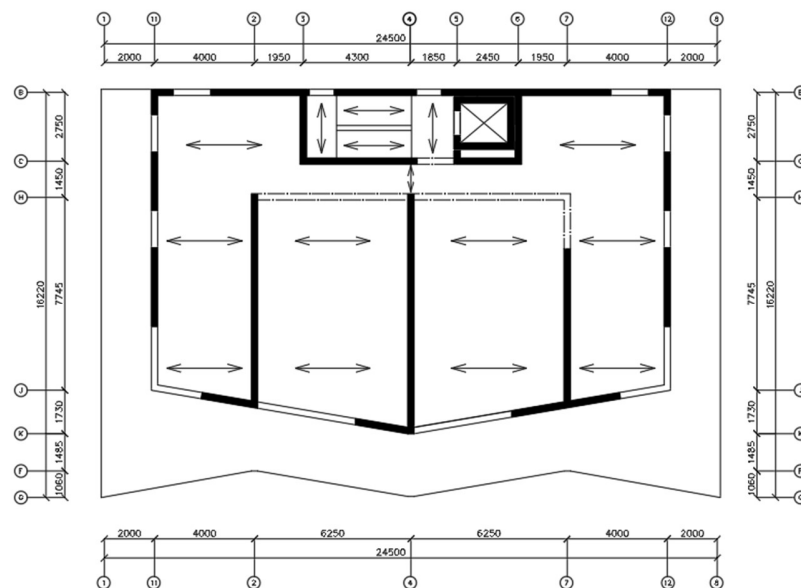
Konstrukční schéma 2.–5. NP
